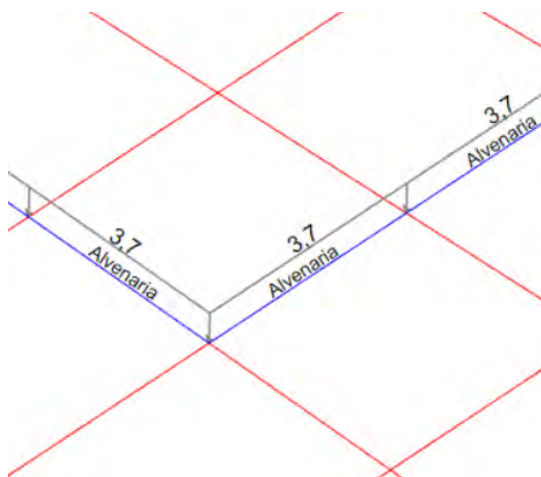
Isométrico da viga extremamente flexível - Carregamento da Alvenaria.
